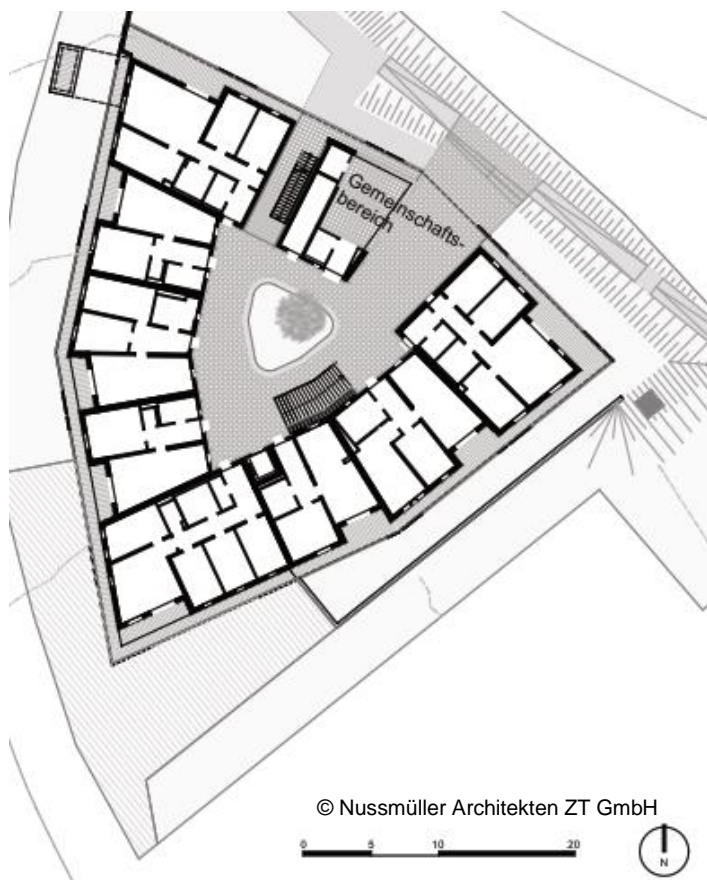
Grundriss des Erdgeschoßes
